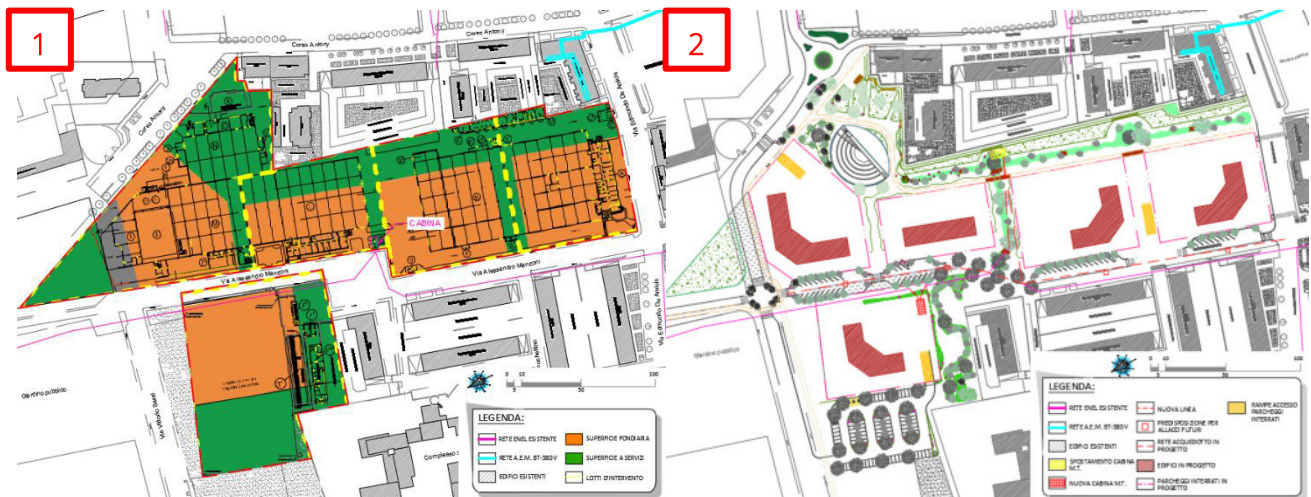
Situazione esistente (1) e di progetto (2) della rete elettrica.
